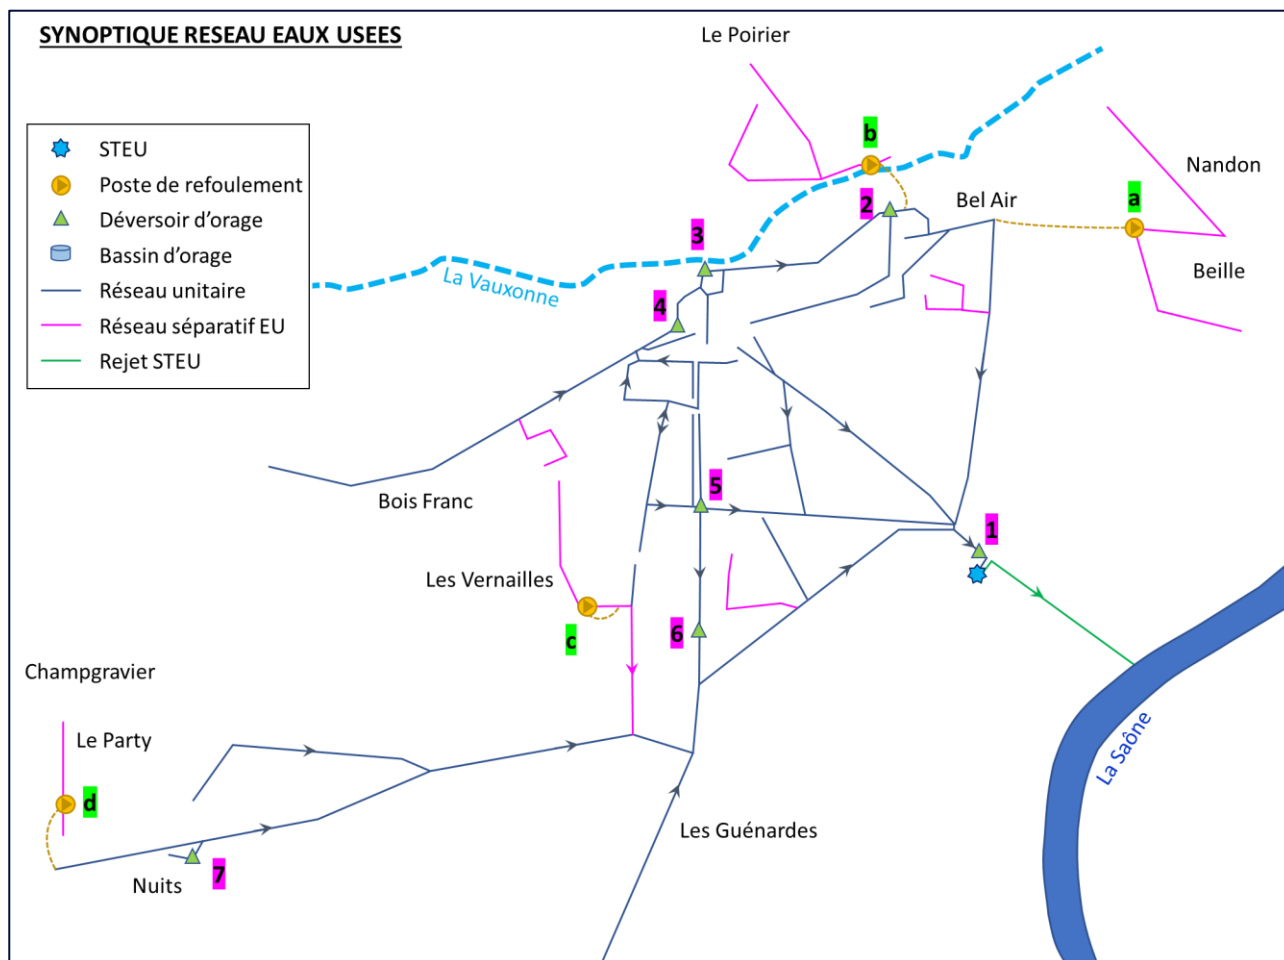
Plan des réseaux d'assainissement des eaux usées
